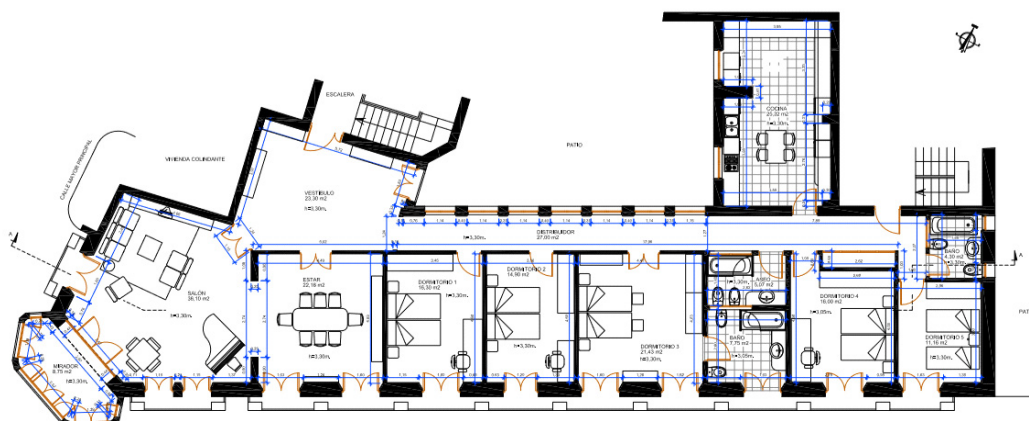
Plano de planta de la rehabilitación inicial propuesta.
